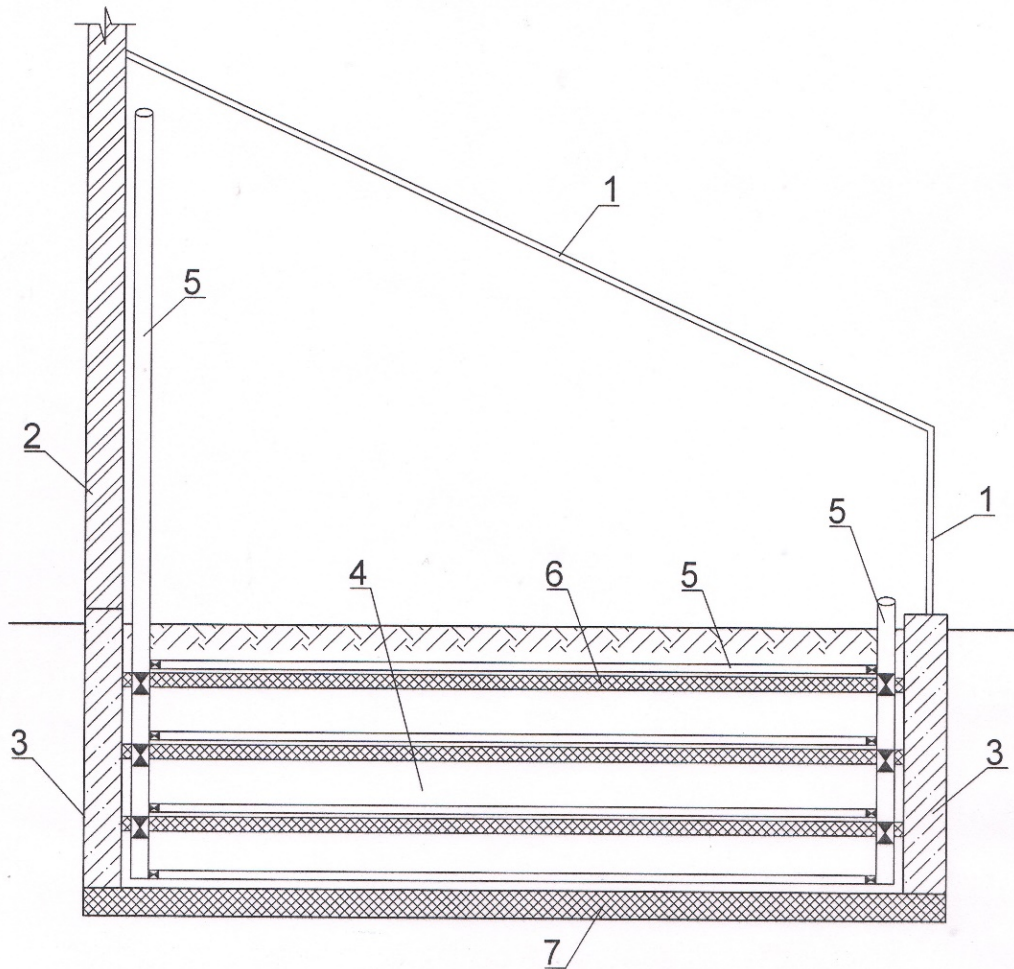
Конструктивна схема теплиці з багатошаровим теплоаккумулятором: 1 – світлопрозоре покриття; 2 – утеплена стіна; 3 – утеплений фундамент; 4 – шар теплоакумулюючого матеріалу; 5 – мережа воздуховодів; 6 – теплоізоляційна прокладка; 7 – теплоізоляційний шар
